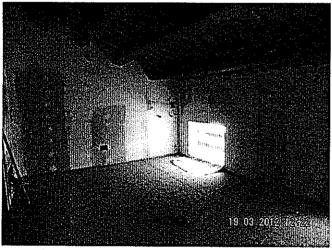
Stanza 2.6: Vista parete esterna con tetto e finestra
